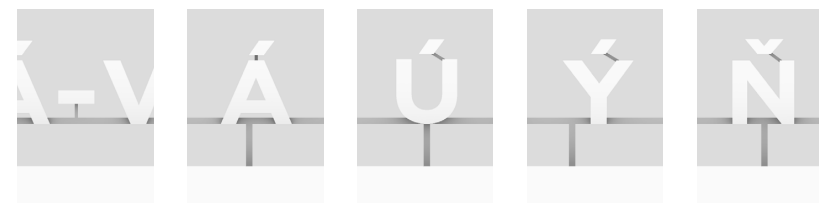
Detail provedení podkonstrukce písmenného názvu
